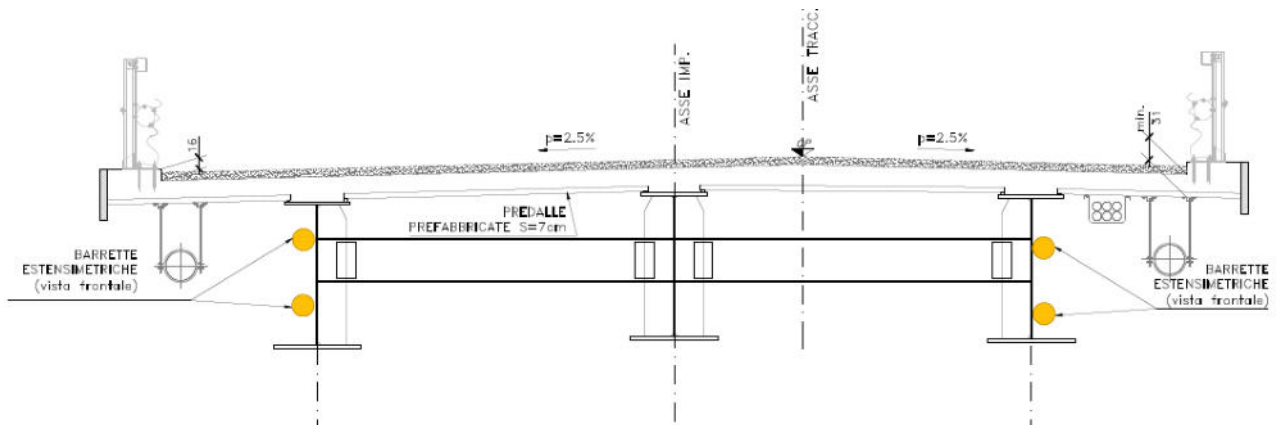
Sezione tipo impalcato posizionamento strumentazione viadotti
